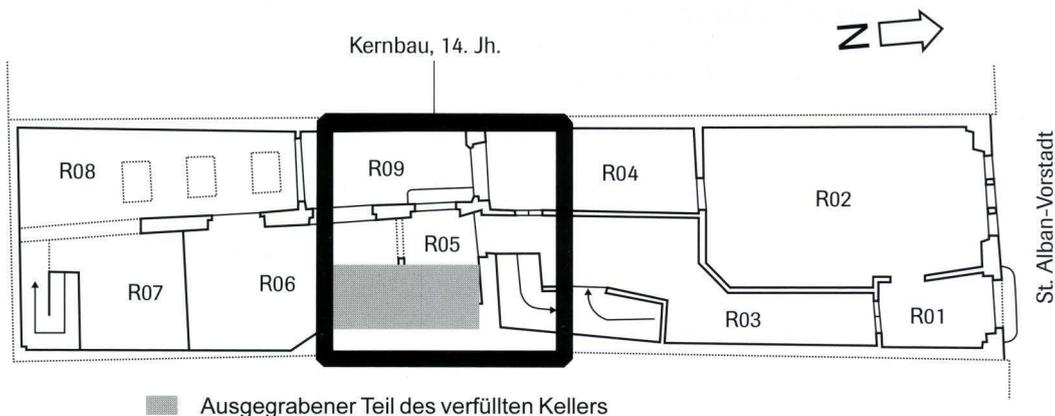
Grundriss von Haus und Parzelle St. Alban-Vorstadt 28. – Nach Helmig et al. 1995. – Massstab ca. 1:200.
